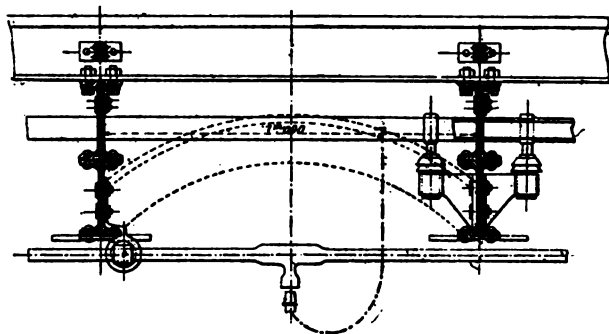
Caniveau circulaire : Coupe longitudinale.
